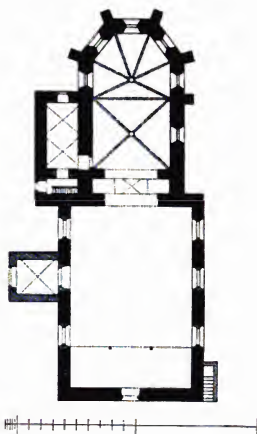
Ševětín. Grundriss der Kirche.
